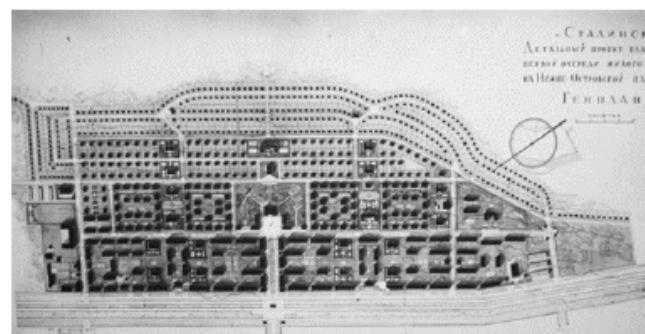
Проектное задание детальной планировки I очереди жилого района на Нижне-Островской площадке г. Сталинска. Генплан. 1958 год. Фото из архива КГЗР г. Новокузнецка
